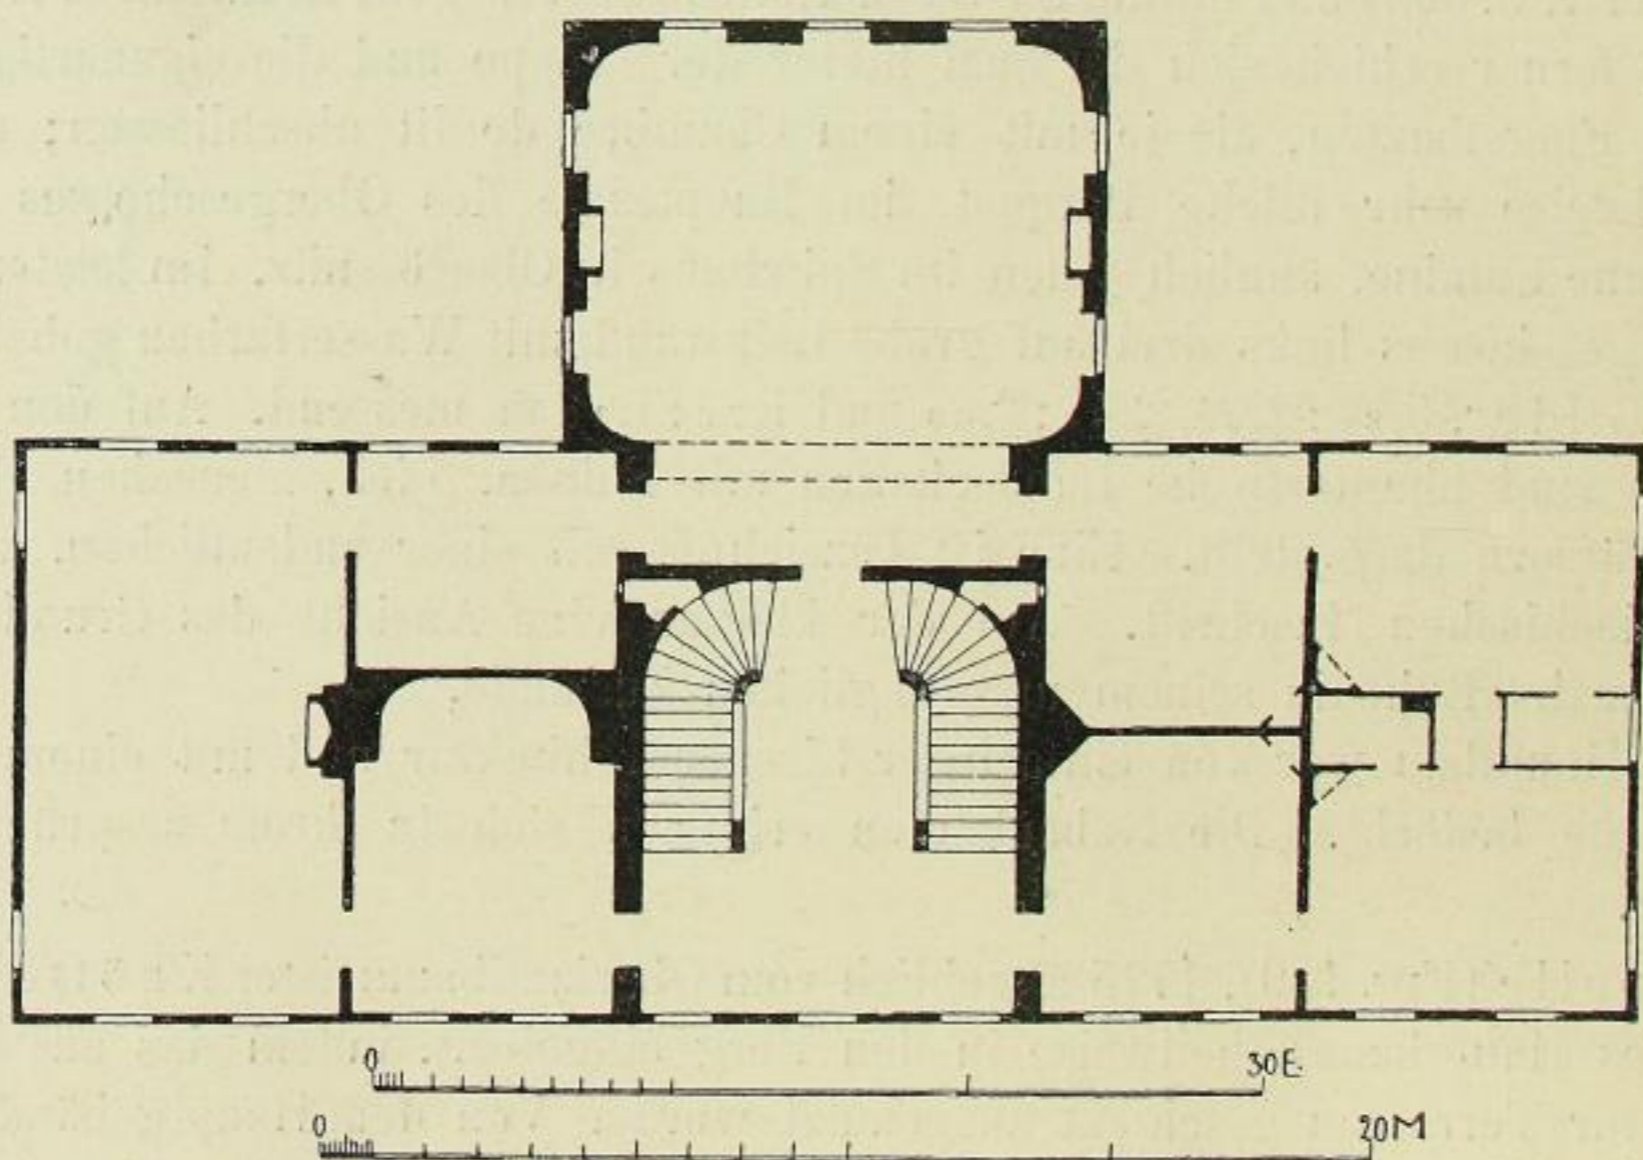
Niederlössnitz, Wackerbarths Ruhe, Grundriss des Obergeschosses.
